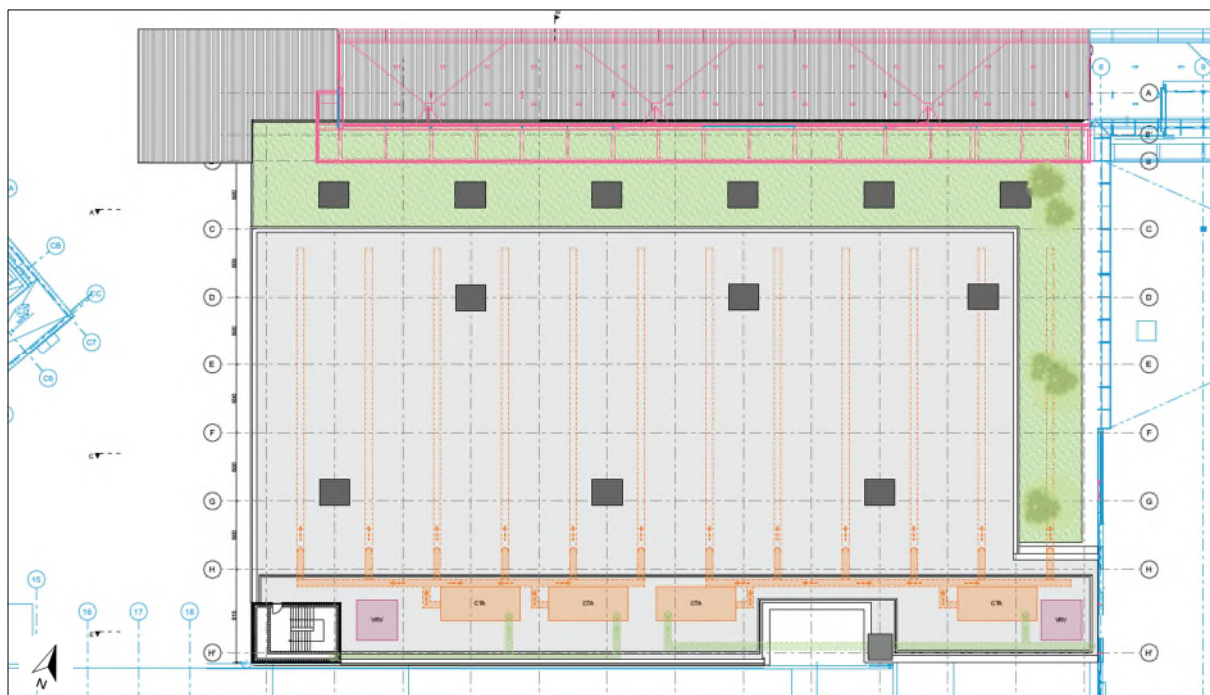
Extension du PIF Nord – Plan R+3 – Niveau +185,00 m (BAG-AERTEC, 2024)
